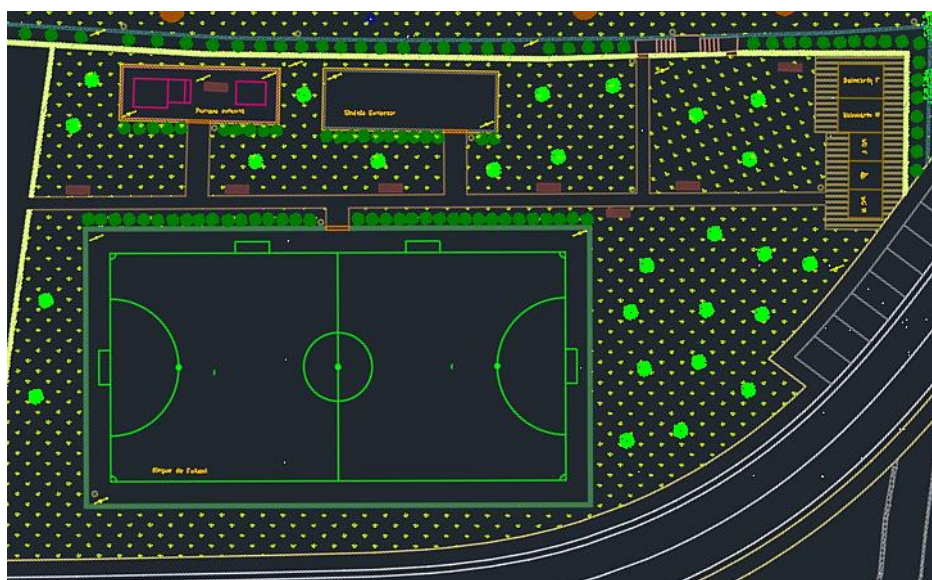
Zona de intervenção Z3 (Fonte: AutoCad Civil 3D)
